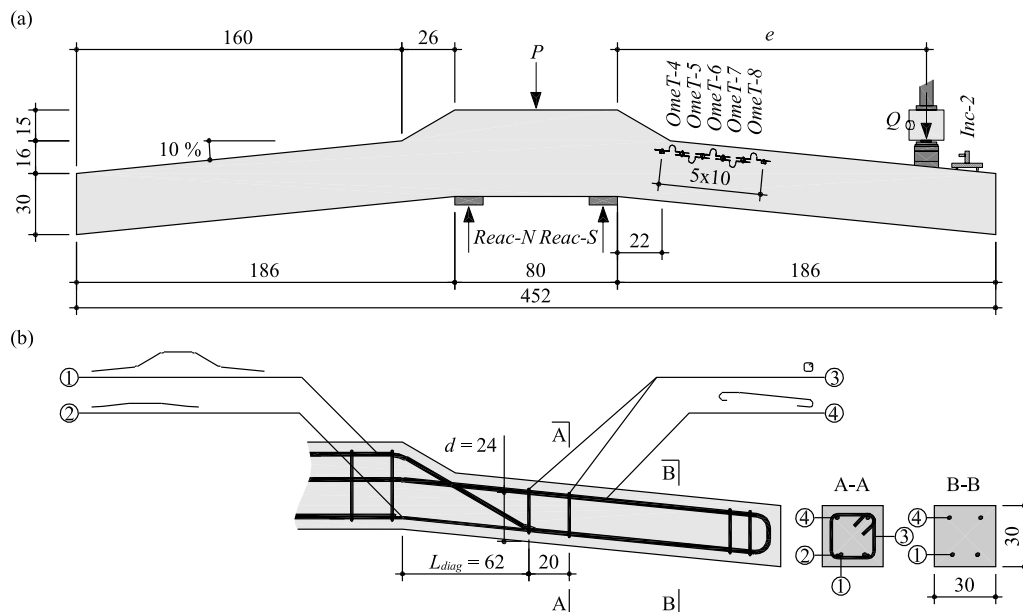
Représentation graphique d'un spécimen; (a) élévation avec dimensions principales [cm], indication des forces et réactions appliquées lors de l'essai ainsi que des capteurs ; (b) plan d'armature des spécimens
